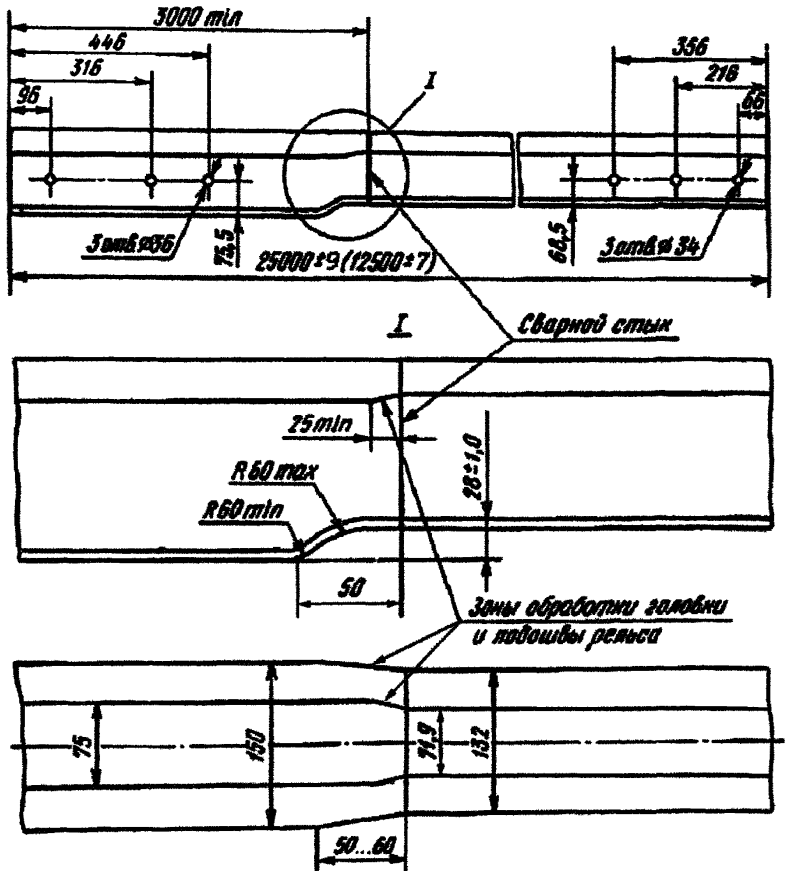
Конструкция и размеры сварного рельса переходного профиля с типа Р65 на Р50
